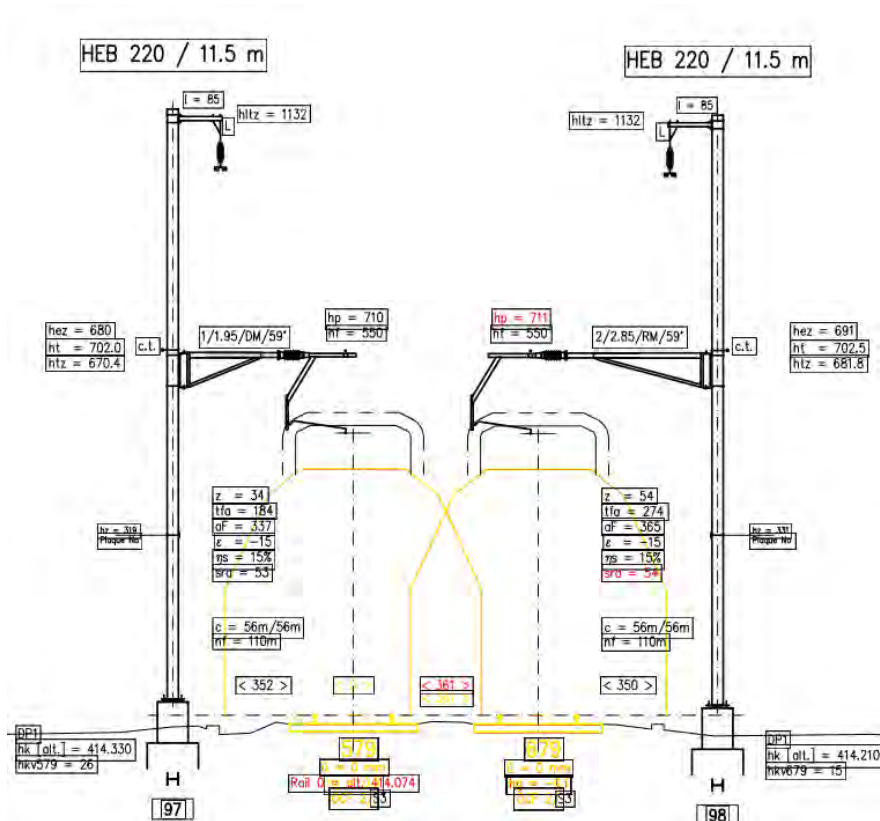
Profil en travers mâts 97-98 [9] (coupe C, vue direction La Plaine) : PK 69.204 de la ligne CFF
